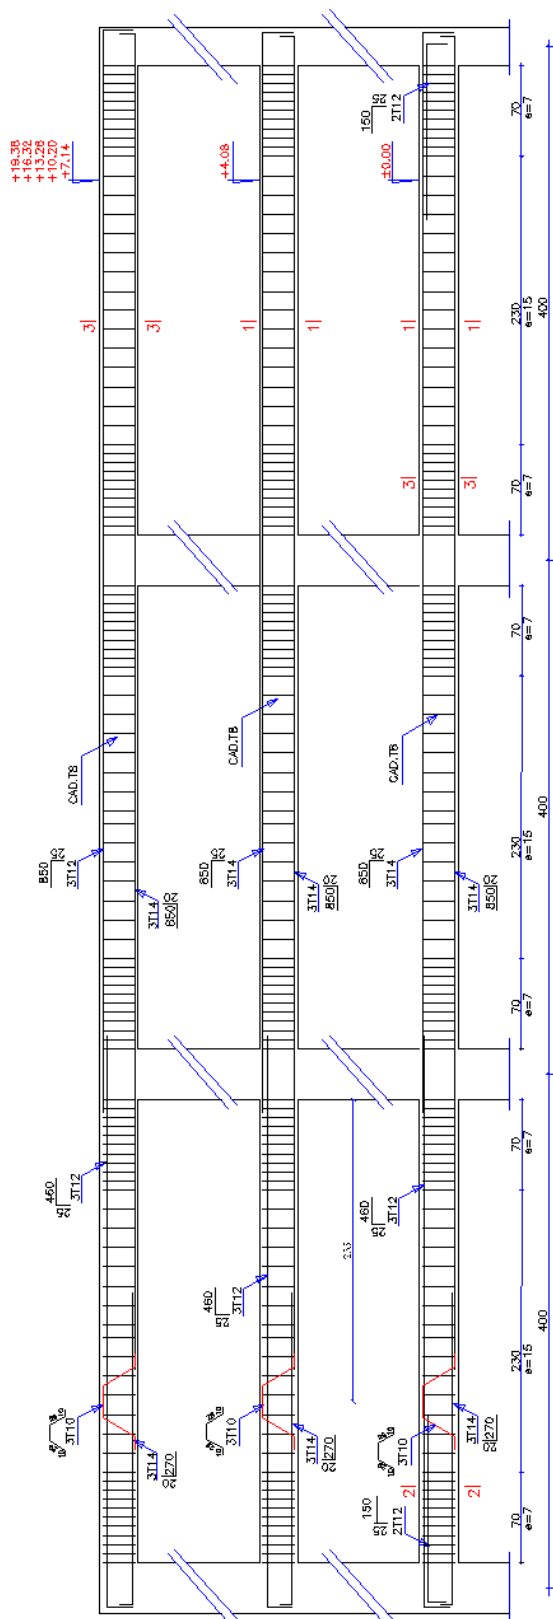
Ferrailage de la poutre secondaire (30x35) cm<sup>2</sup>
